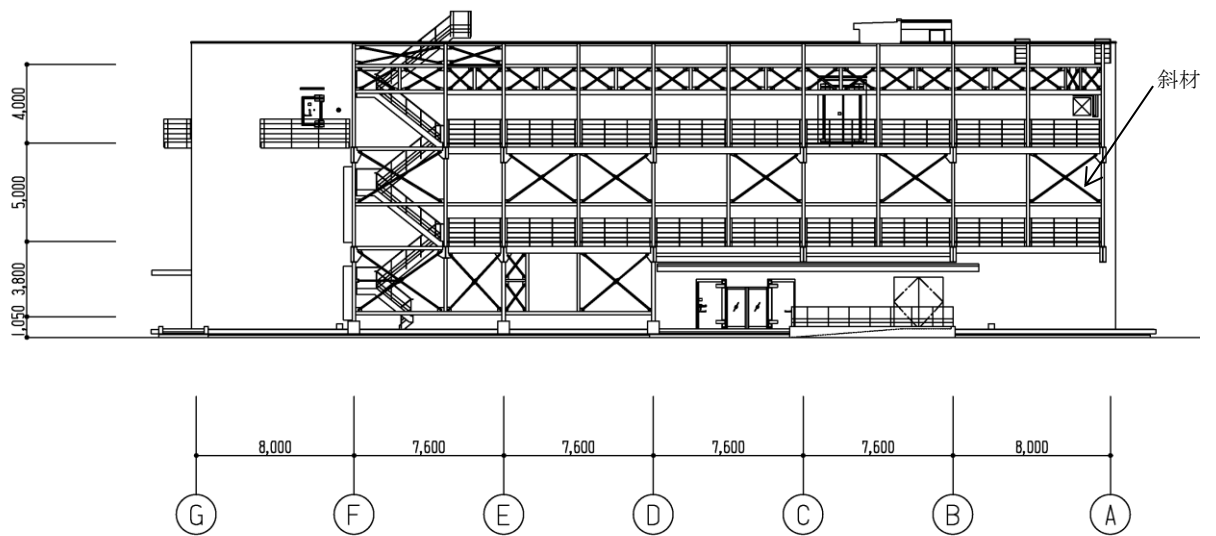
免震重要棟鋼製バルコニーの立面図
